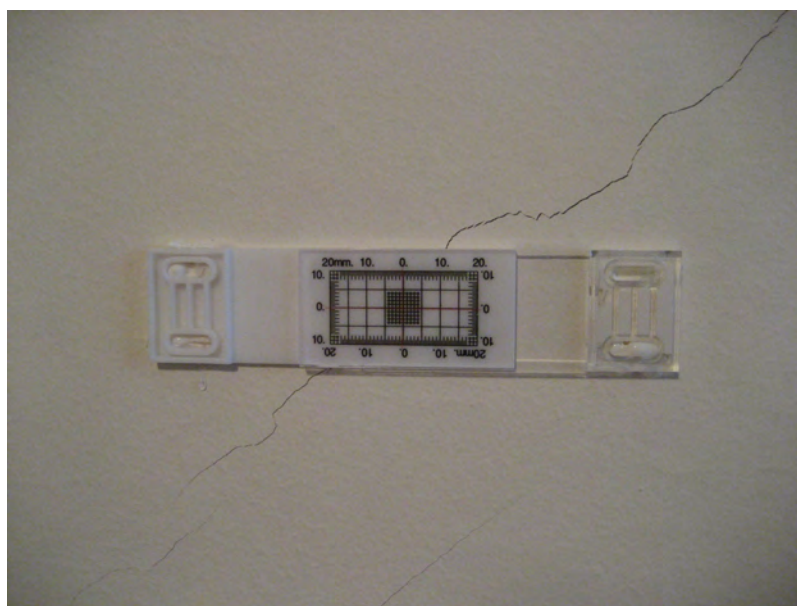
Fisuròmetre instal·lat damunt d'una fissura.
